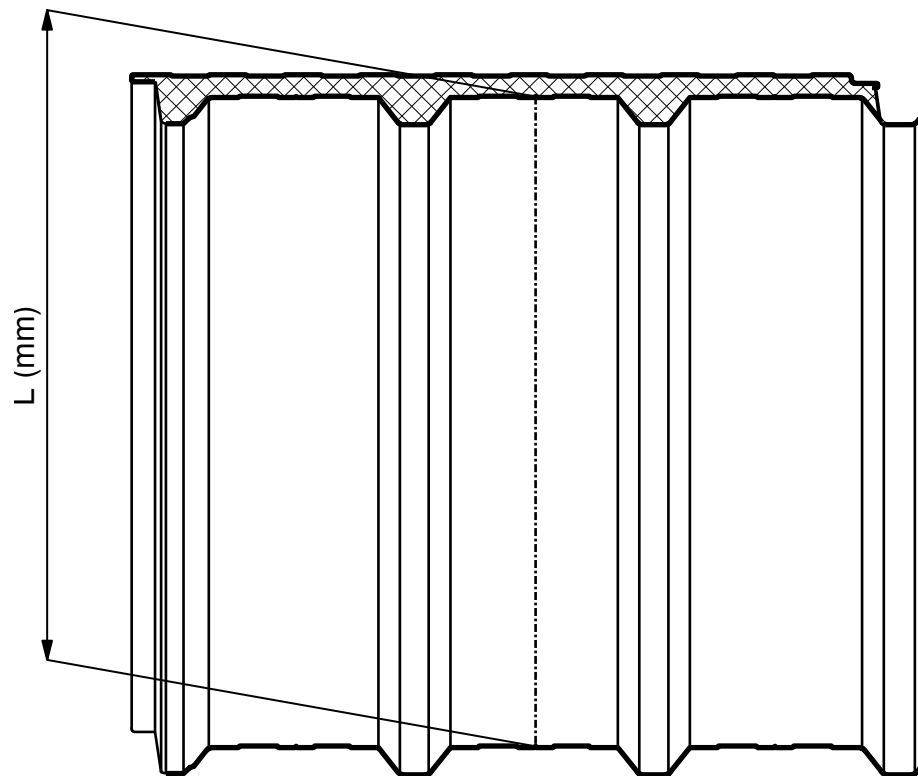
Länge (gemessen an einem Dachelement, am mittleren Untergurt)
